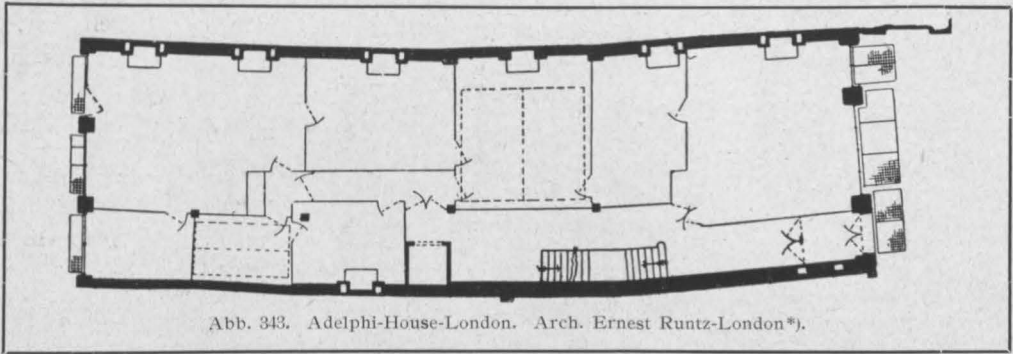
Adelphi-House-London. Arch. Ernest Runtz-London\*).
